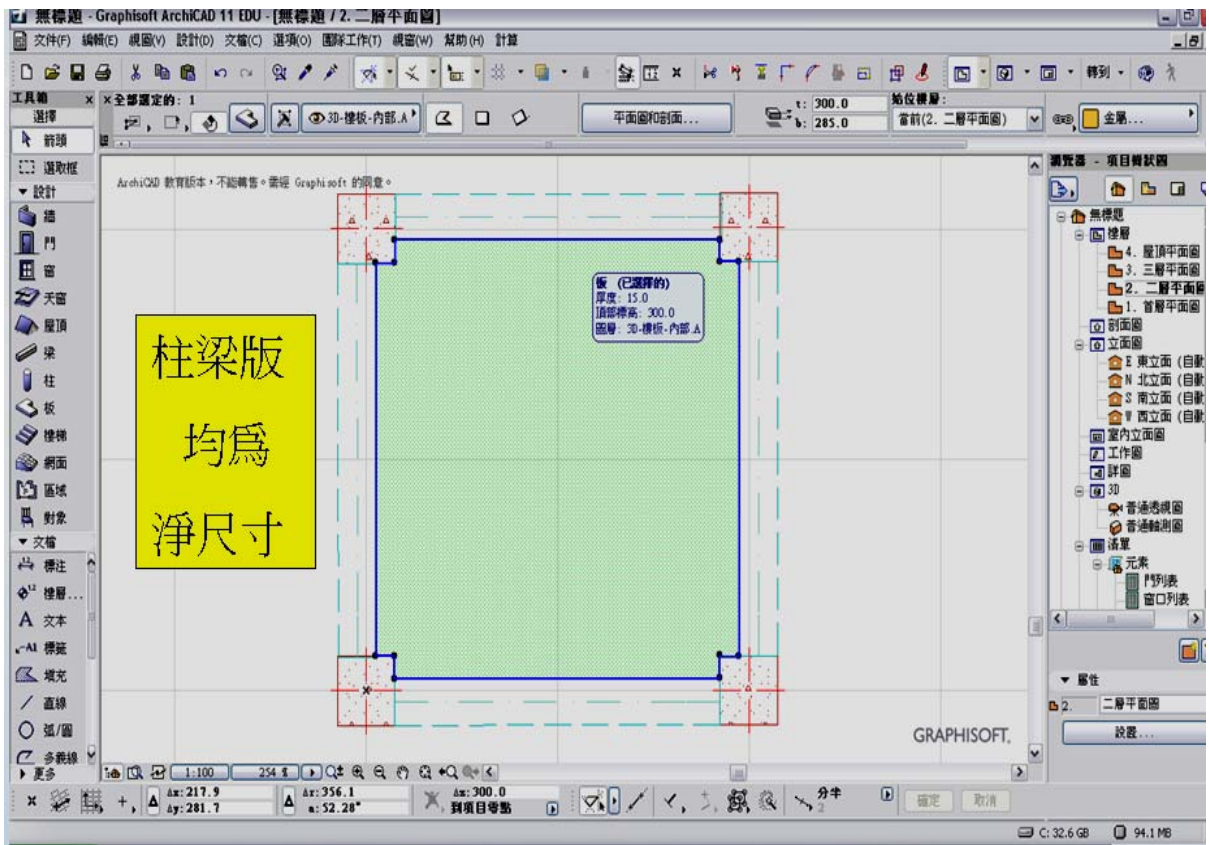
ArchiCAD 柱梁優先模式 2D 平面圖
